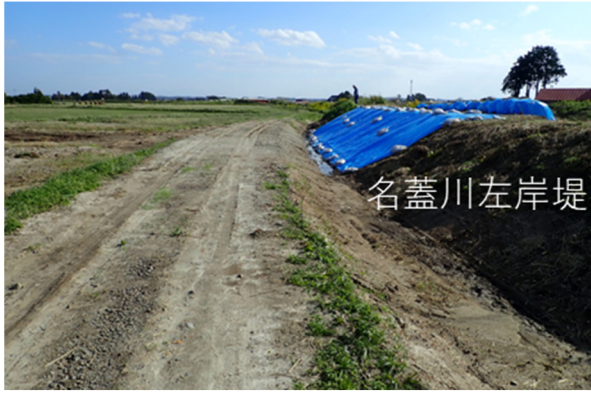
名蓋川 b 地点左岸決壊箇所
